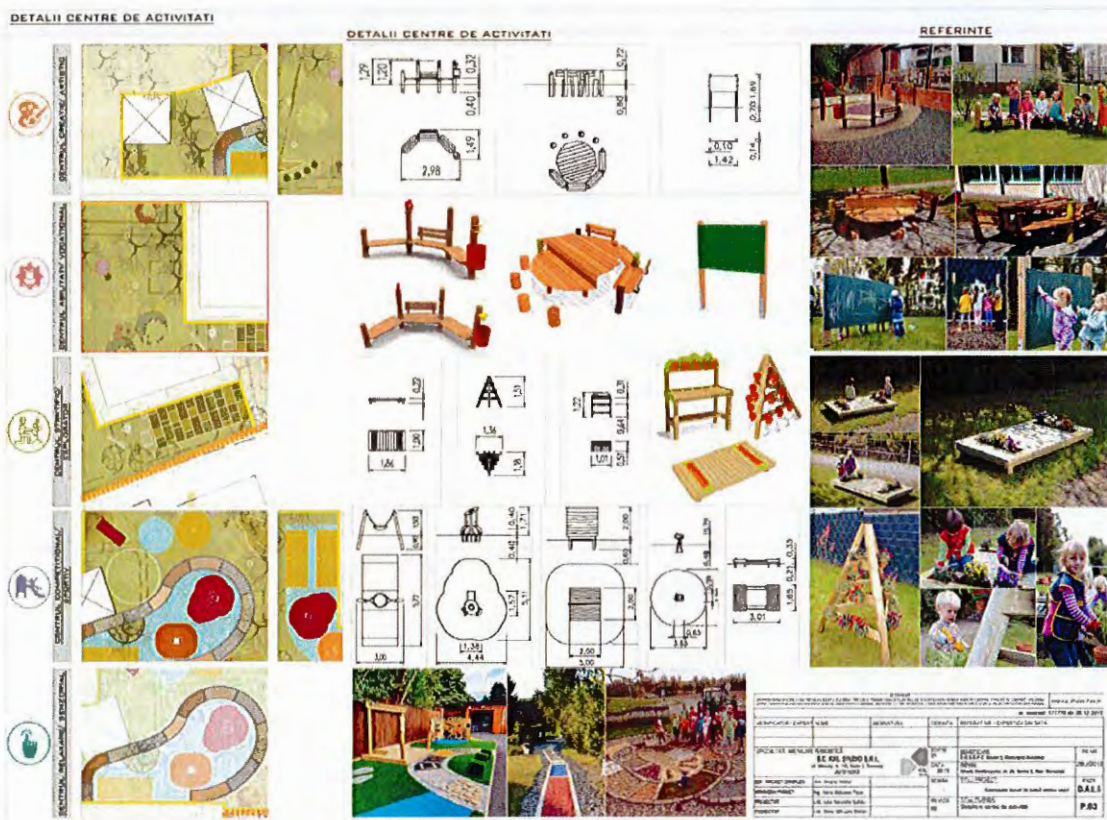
Plan amenajare propus Ciobanasului Nr. 23
